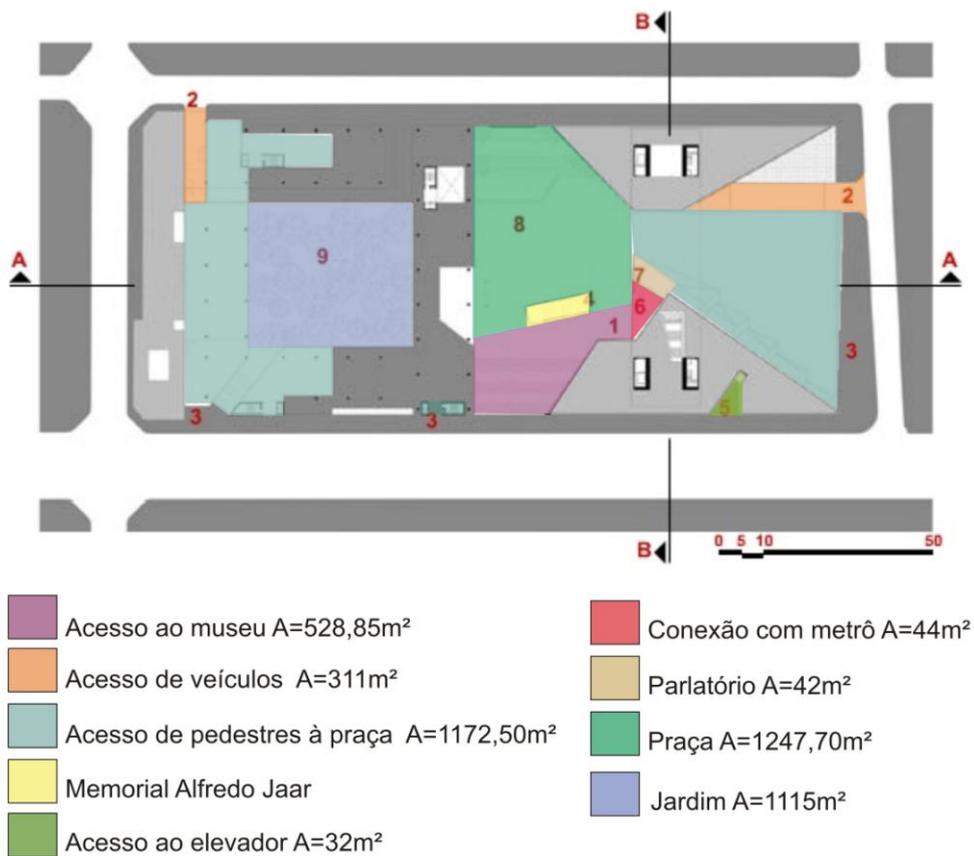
Planta Baixa Nível 0,00 (ARCOWEB, 2010)
